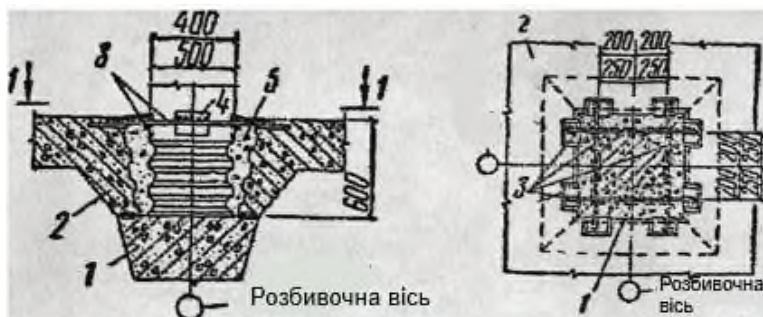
Вузол з'єднання капітелі з колоною (серія 1.420-4): 1 - колона; 2 - капітель; 3 - сталева накладка; 4 - монтажний зварний шов; 5 - монолітний бетон
